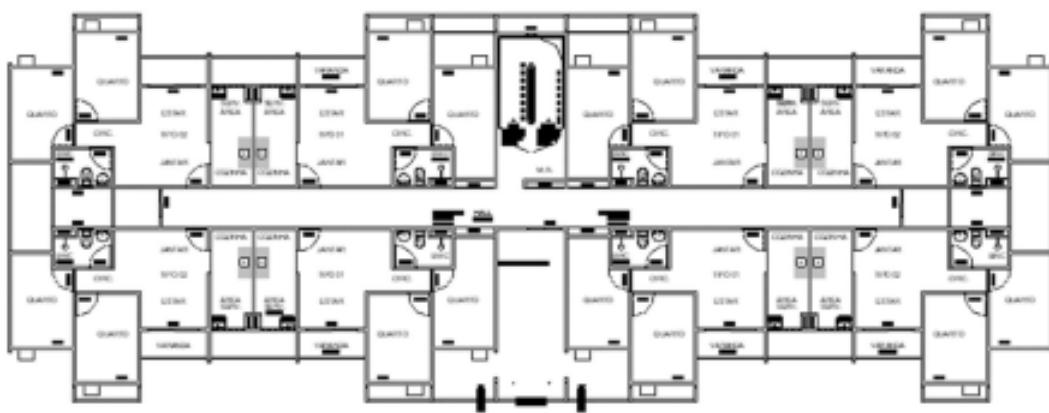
Parede de concreto 03, planta baixa do pavimento tipo
